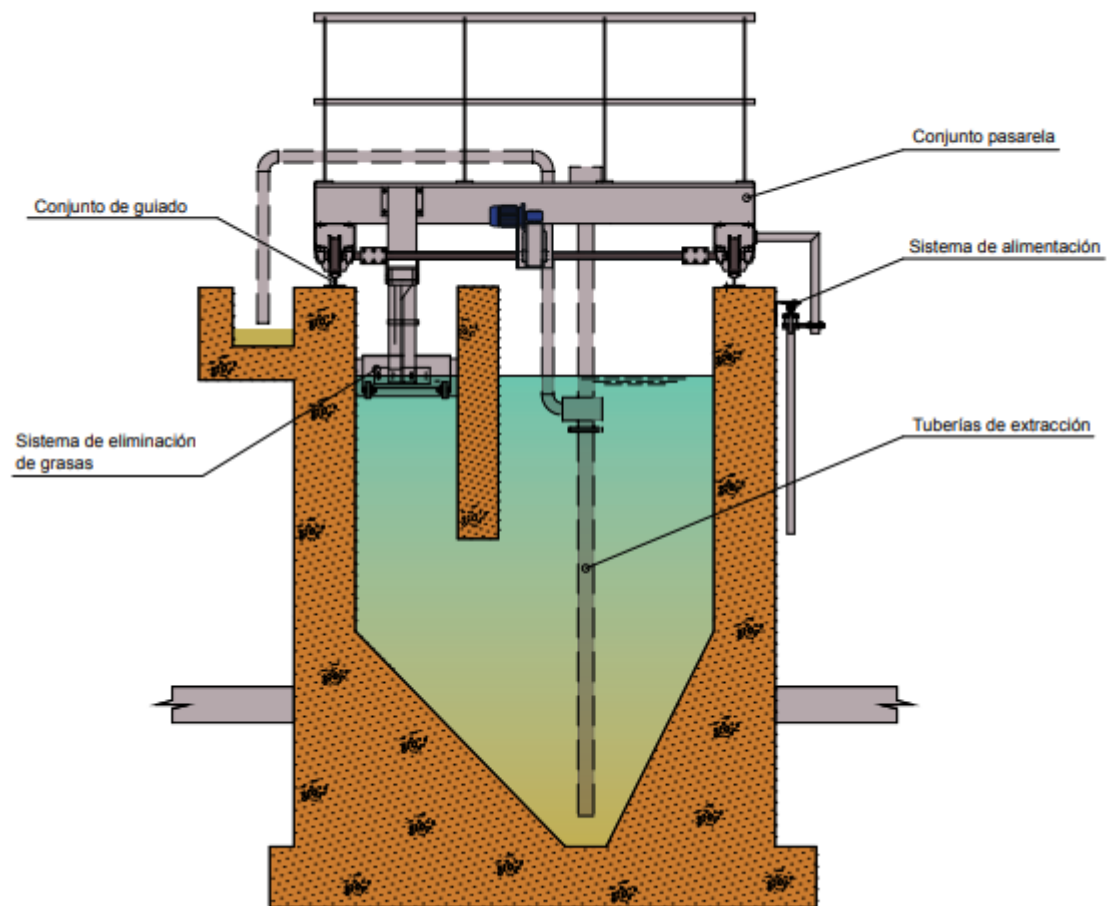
Vista transversal de Puente Desarenador-Desengrasador. Fuente: Catálogo DAGA
